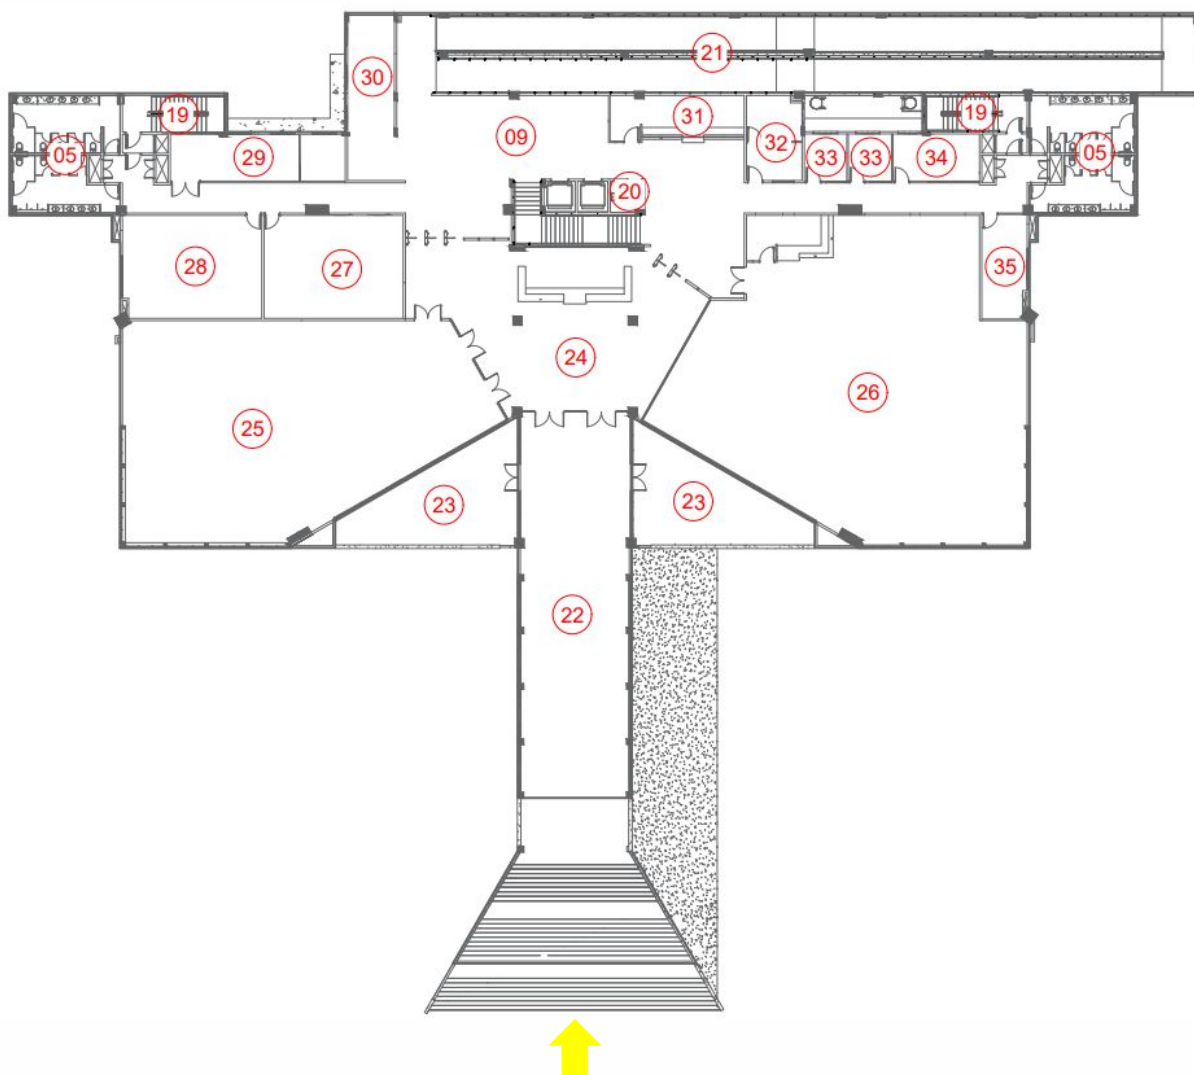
Identificação dos Ambientes no Primeiro Pavimento
